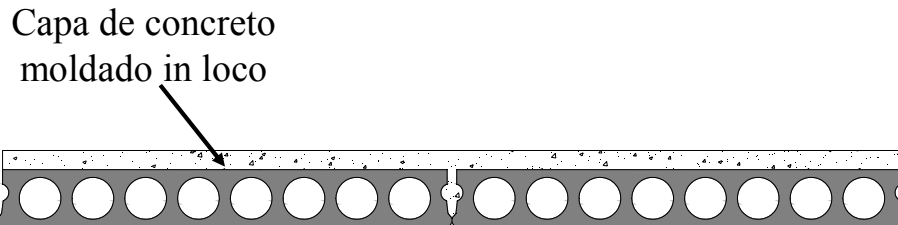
Uso de capa estrutural em concreto moldado in loco.
